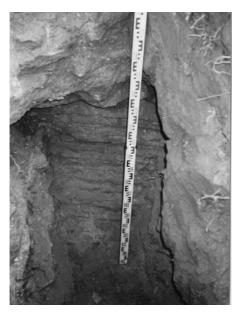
Конструкция полукруглой подпорной стены (шурф № 27)
